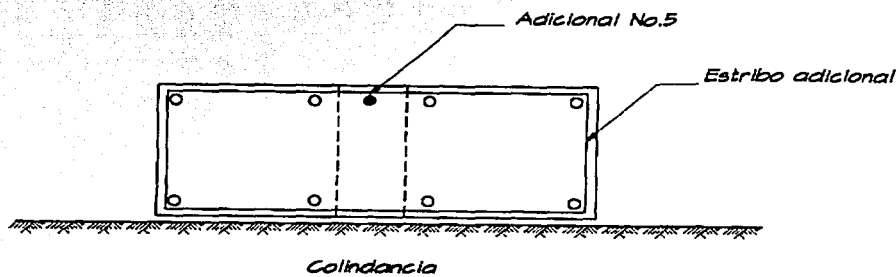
, armado de las columnas en los ejes 7 y 8.
